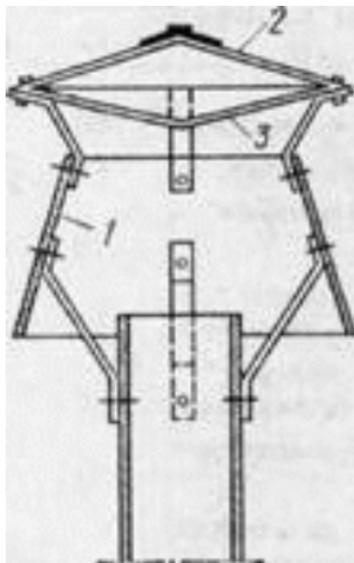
Дефлектор конструкции Григоровича: 1 – диффузор; 2 – колпак; 3 – обратный конус
